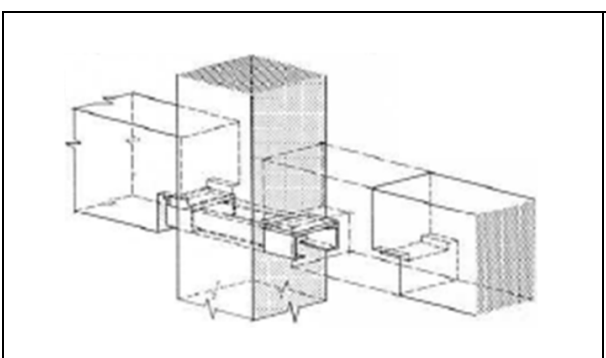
Ligação por consola curta metálica (Stupré, 1981)
